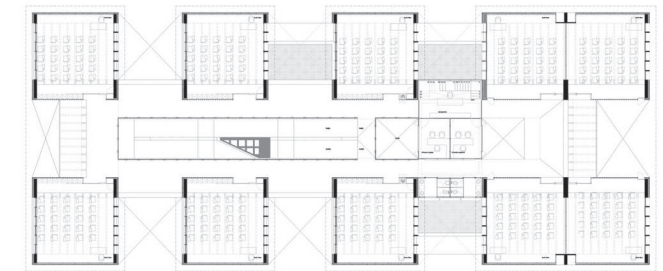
PLANTA ARQUITECTONICA ESCUELA NUEVO CONTINETE. Fuente: (Arch Daily, 2014)
